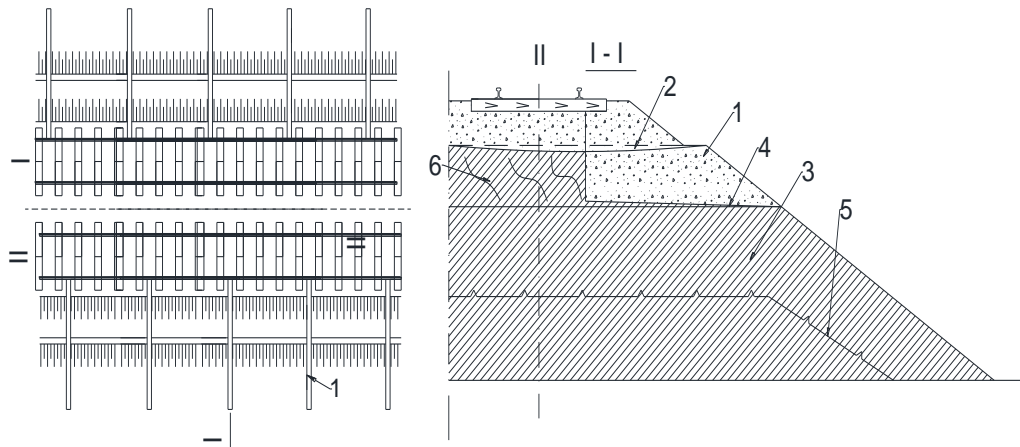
Поперечные дренажные прорезы для осушения пучинистого грунта: а – план расположения прорезей на двухпутном участке; б – поперечный разрез насыпи, сечение 1 – 1; 1 – поперечная дренажная прорезь; 2 – балластное ложе; 3 – пучинистый грунт в зоне сезонного промерзания; 4 – крупный щебень на выпуске воды из прорези; 5 – граница сезонного промерзания грунта; 6 – слой грунта, распученный ледяными прослойками и линзами
